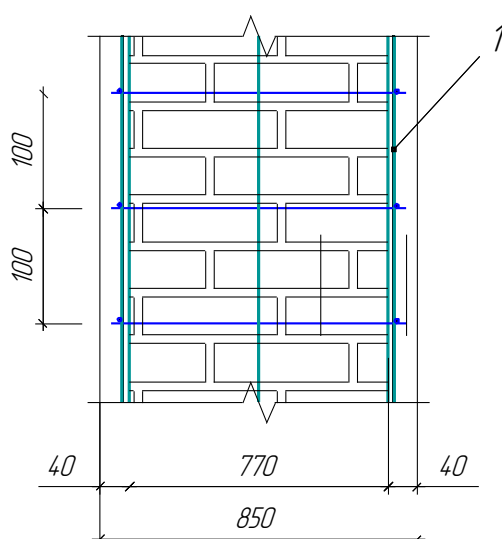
Усиление столба армированной штукатуркой (растворной обоймой)
